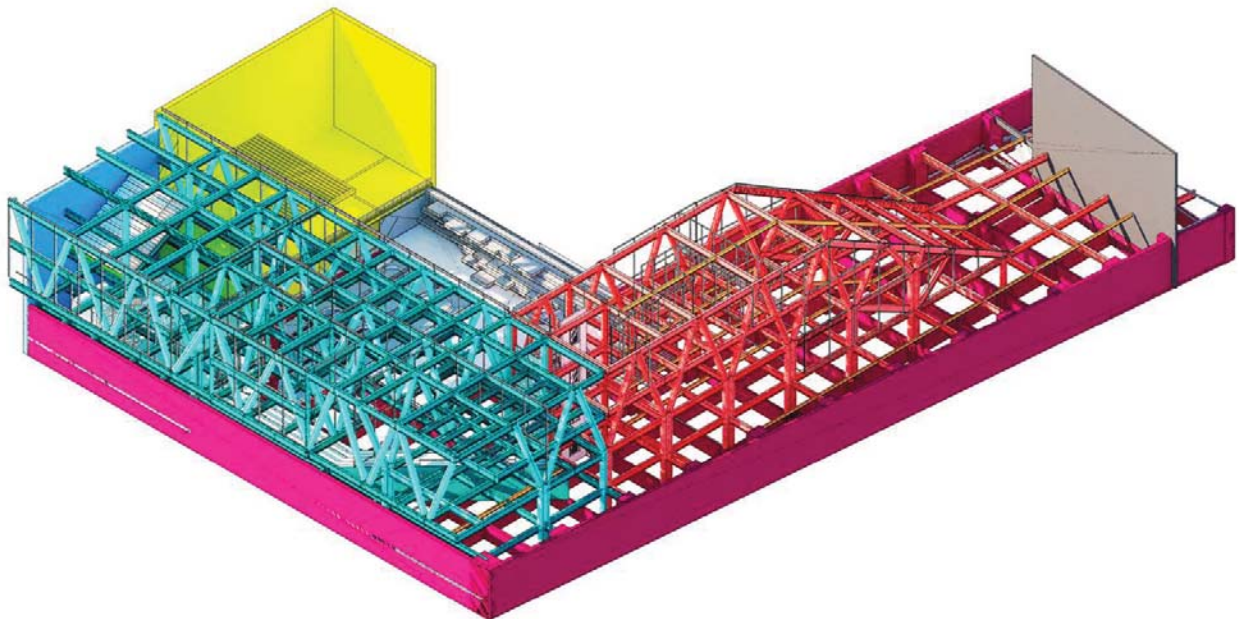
Diagrama de separación estructural, [elaboración propia].
